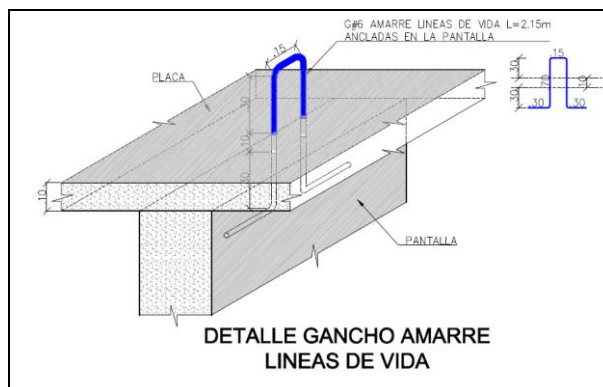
Gancho instalado en la estructura, como punto de anclaje
